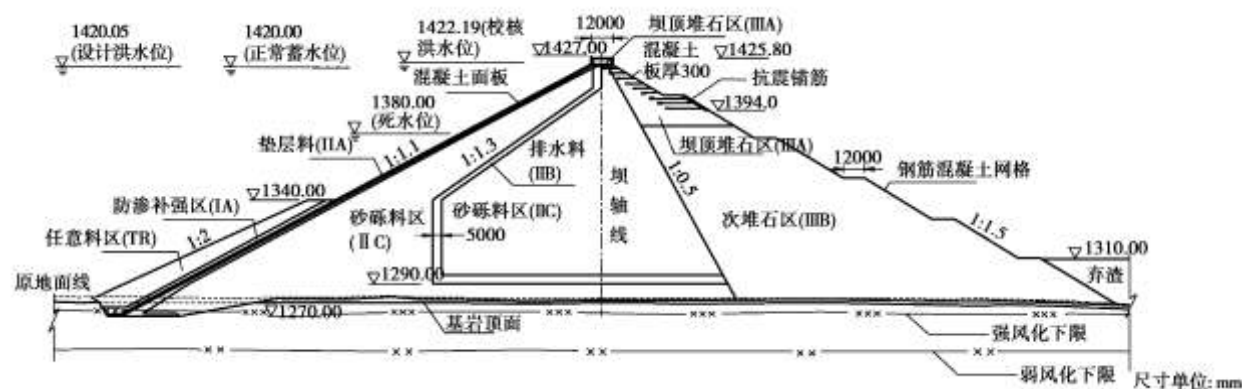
吉林台一级水电站混凝土面板砂砾石坝典型剖面图
